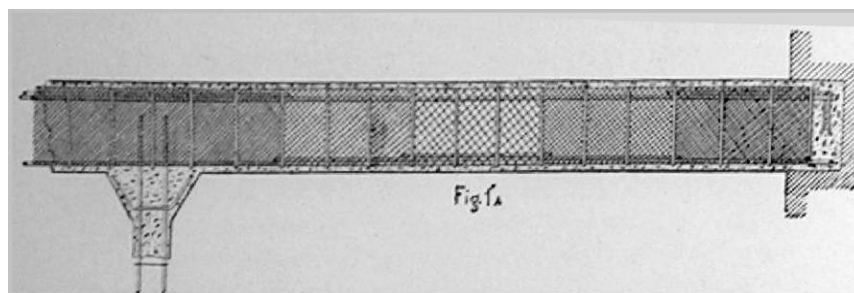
Disposición de armadura de la patente de Ribera. Ribera, 1902.
